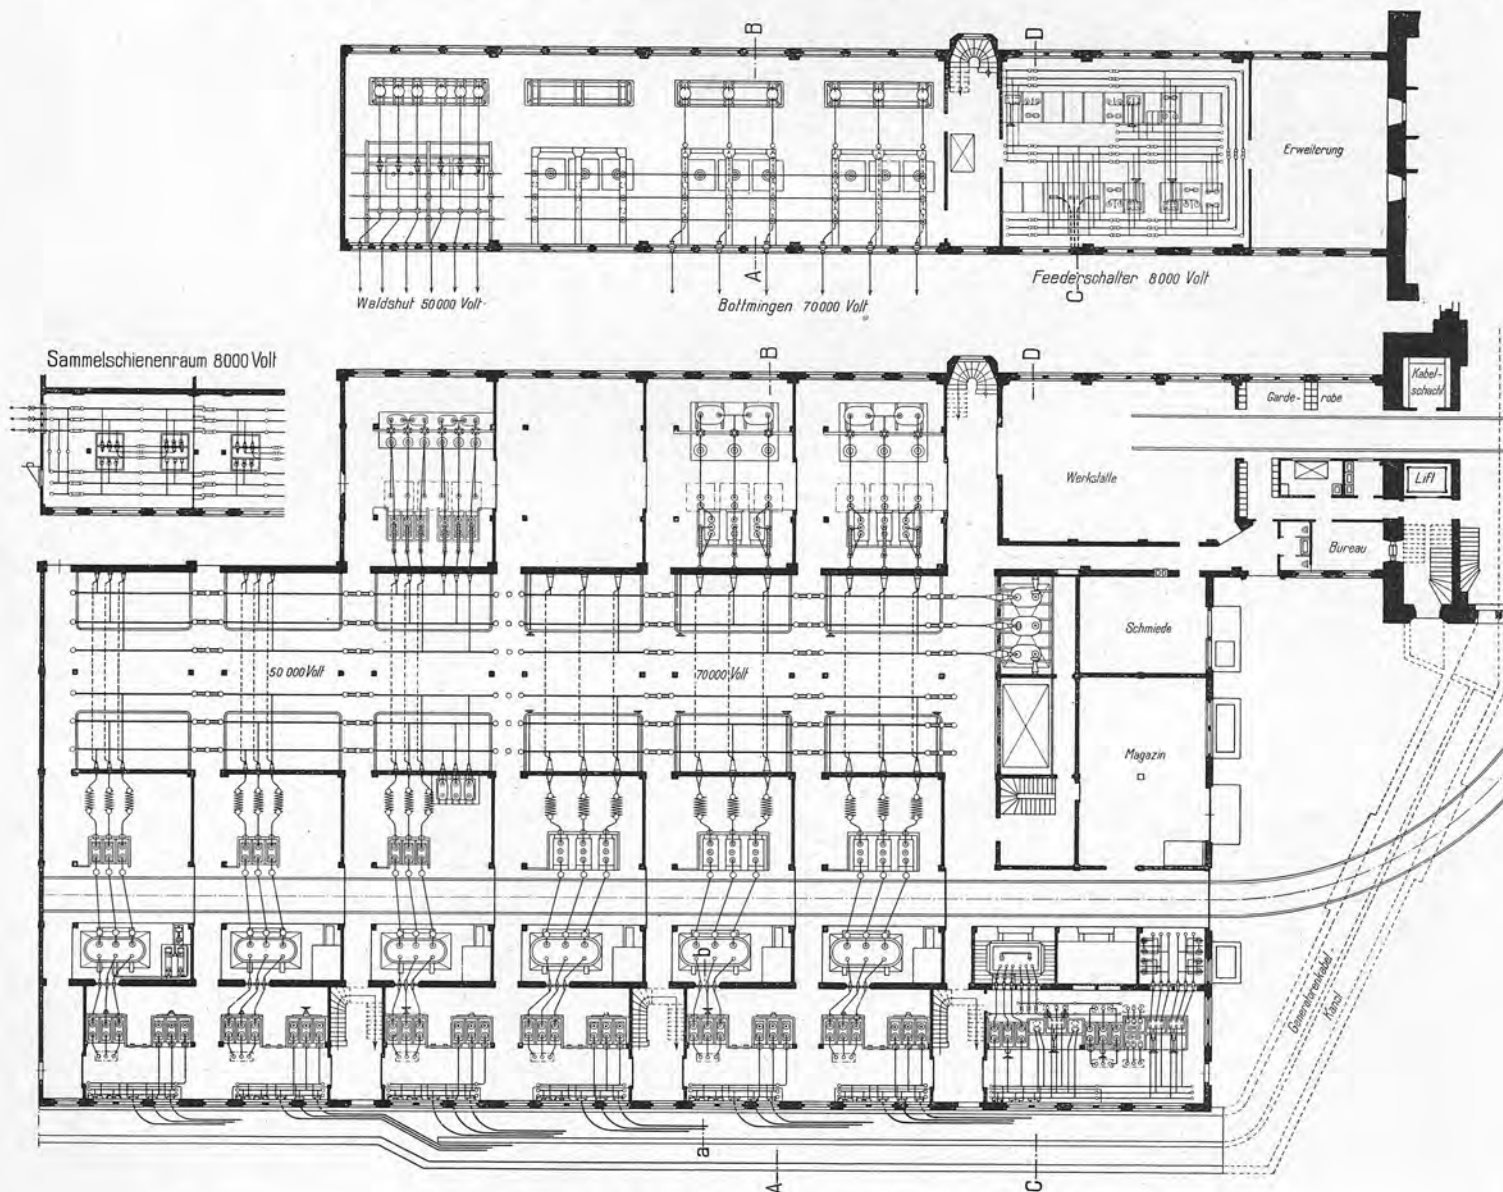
Grundrisse des Schalthauses des Kraftwerks Gösgen. — Masstab 1 : 400.
